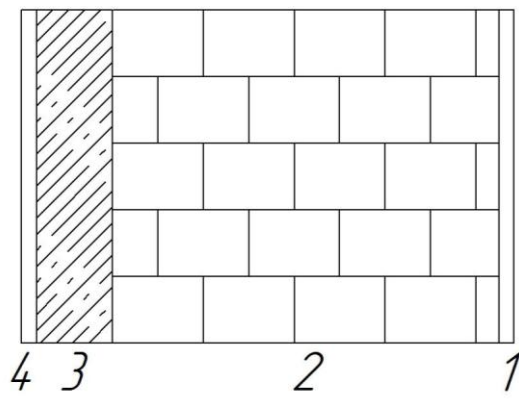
Эскиз наружной стены после реконструкции
